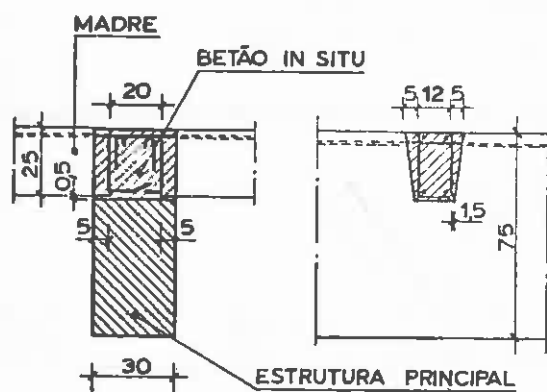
Ligação de madres à estrutura principal de cobertura (viga, asna, etc.) (2)
